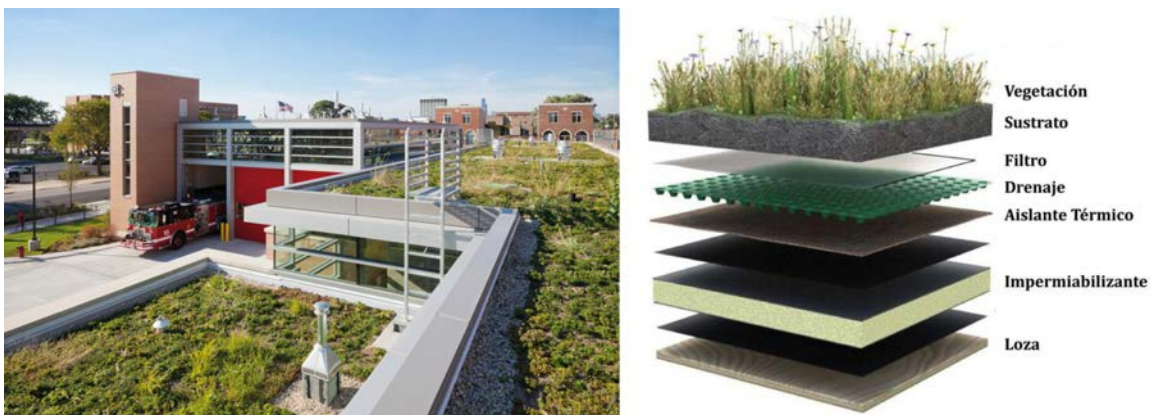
Sistema de aplicación de cubierta verde. Obtenido de: <https://n9.cl/xmyoa>
